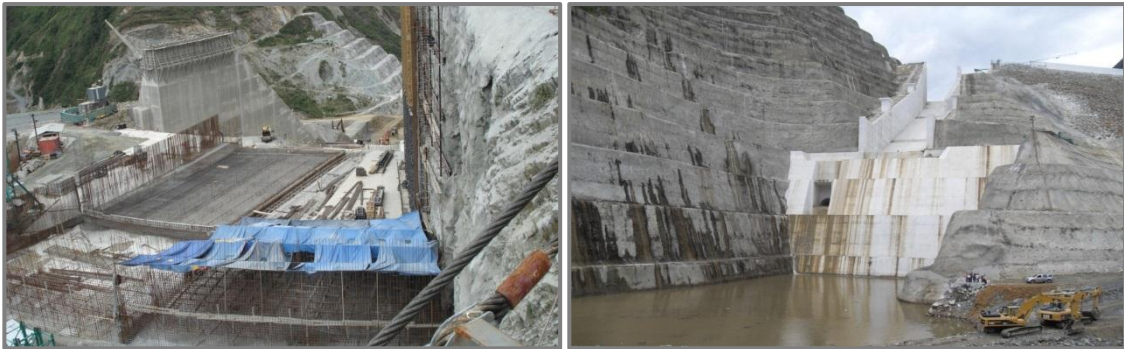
a) Armadura de la losa, encofrado deslizante y tubería de alimentación del hormigón, b) Excavación y estabilización de los taludes en la zona donde fue construido el vertedero (Fuente: Caminosca, 2011)
